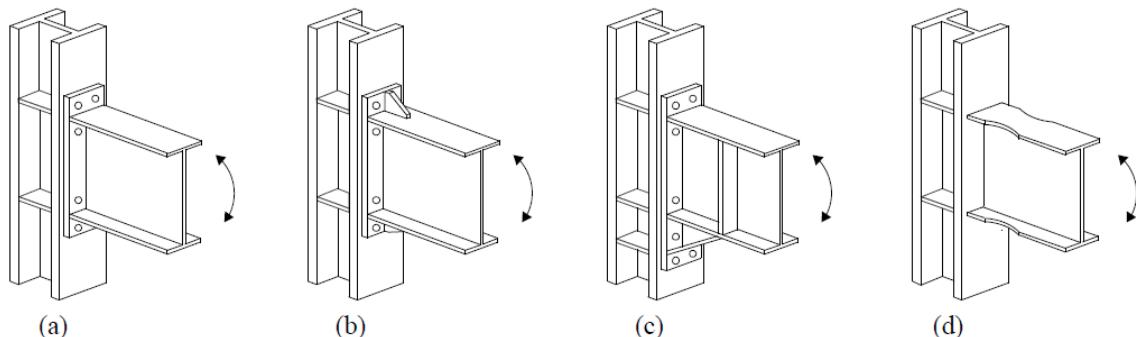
Assemblages poutre-poteau préqualifiés dans le cadre du projet EQUALJOINTS : a) Assemblage boulonné, b) Assemblage boulonné avec platine d'extrémité raidie boulonnée, c) Assemblage boulonné avec renfort et platine d'extrémité non raidie, d) Assemblage soudé en forme d'os de chien
